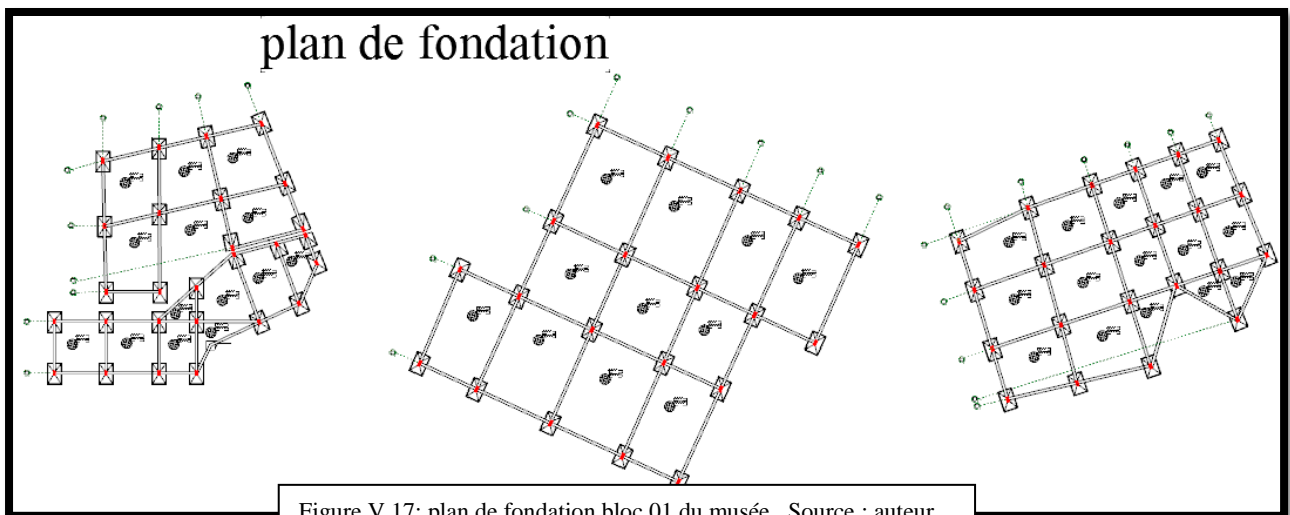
plan de fondation bloc 01 du musée Source : auteur
